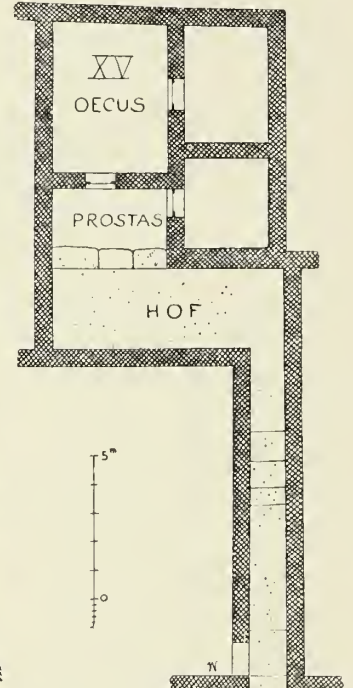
Grundriss des Hauses Nr. XV.
